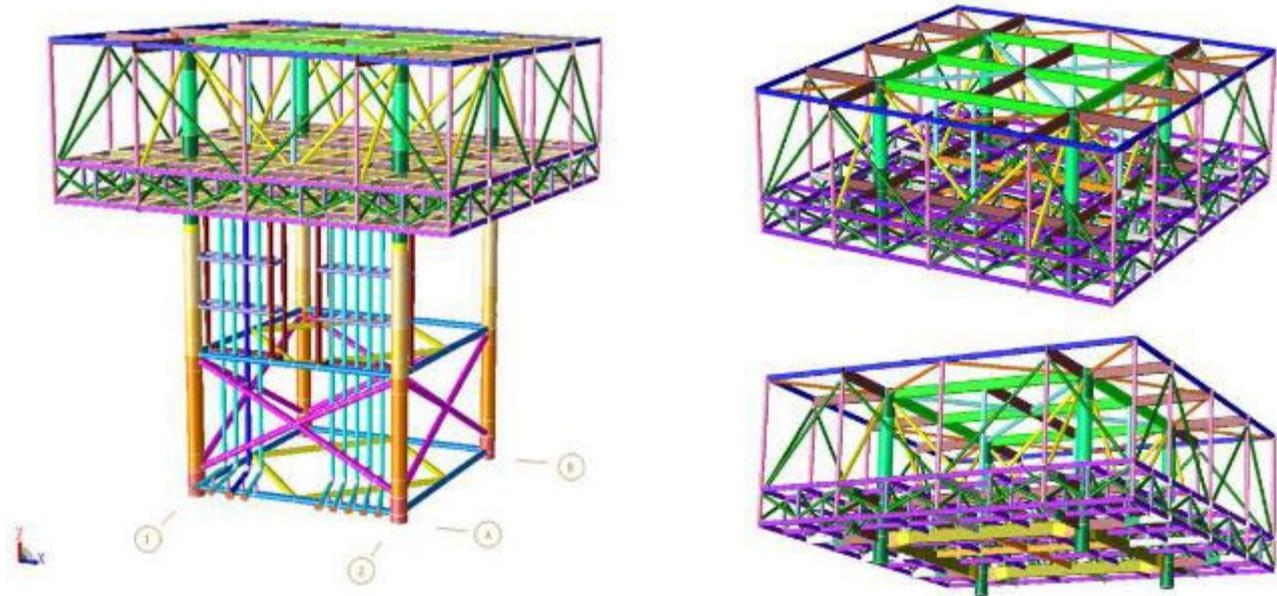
Sezione prospettica della Stazione Elettrica di Trasformazione
